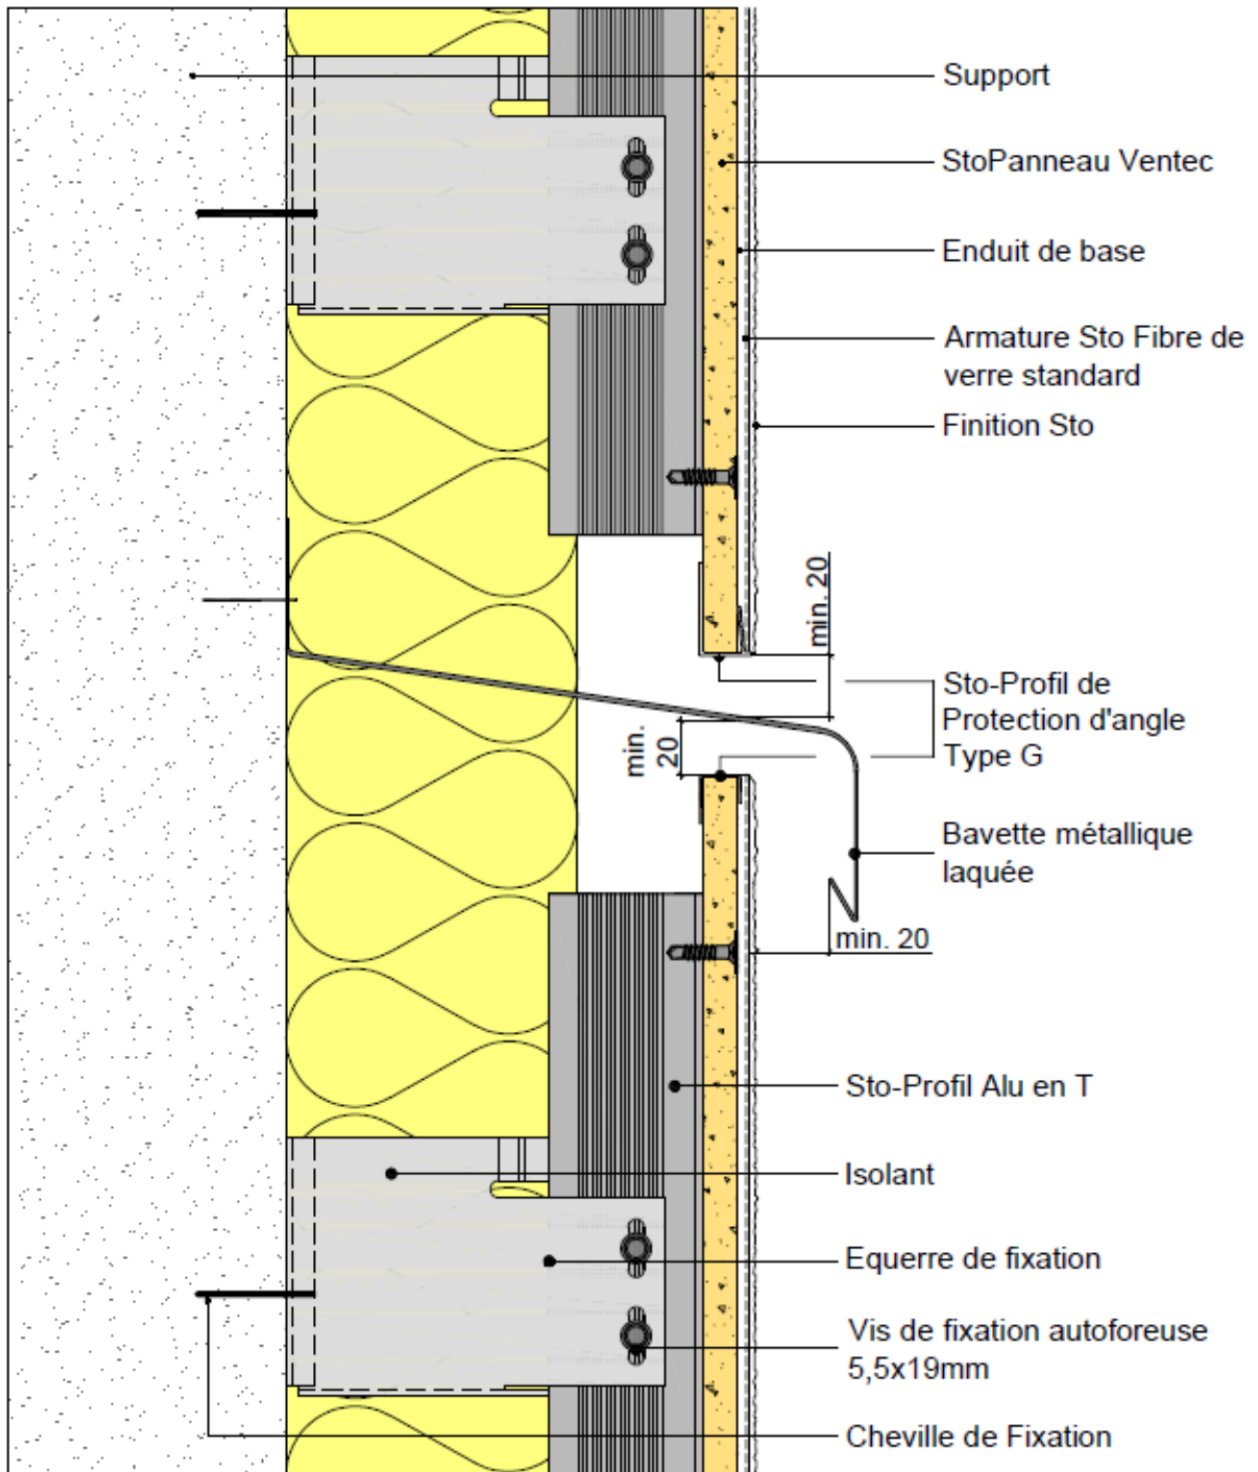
Coupe verticale - Fractionnement du système - Recouplement de lame d'air
